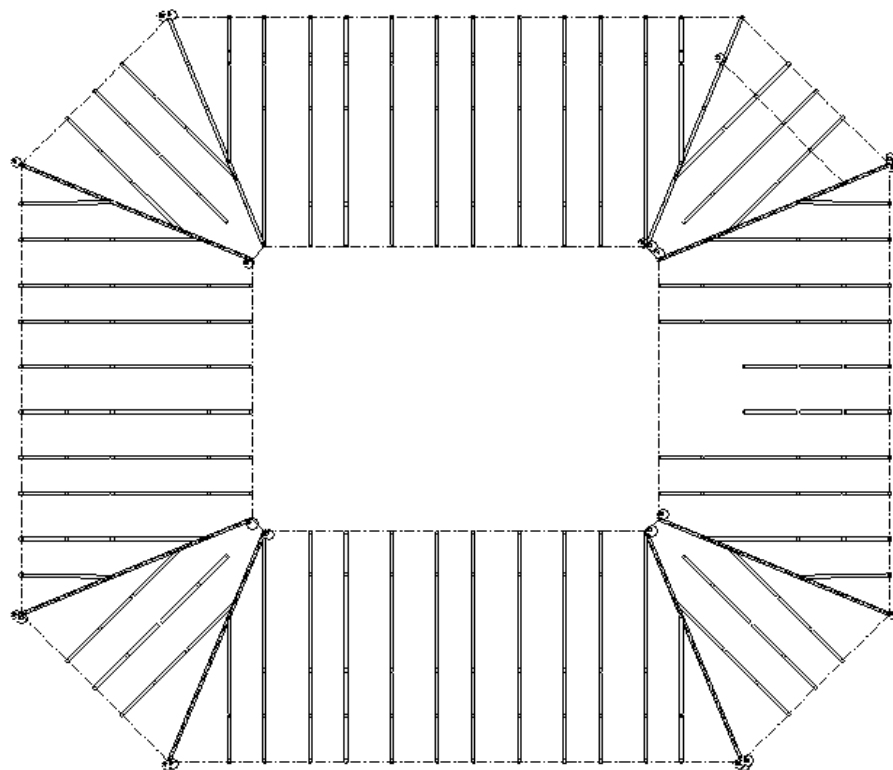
Vista en planta de la distribución de vigas. Fuente: elaboración propia.
